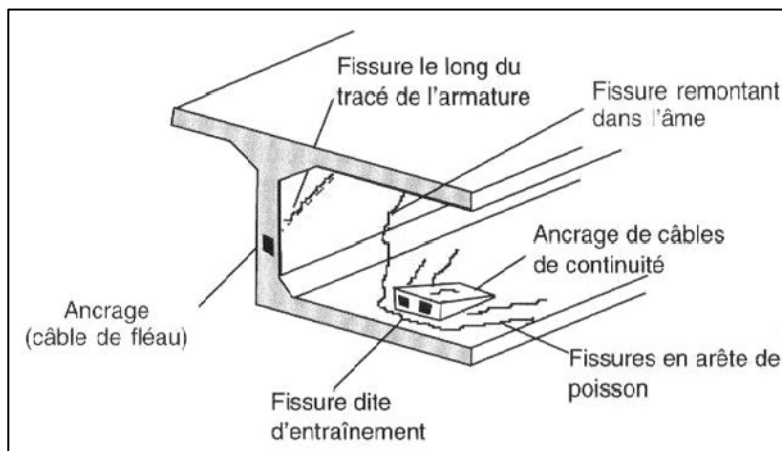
Fissurations de diffusion et d'entraînement
